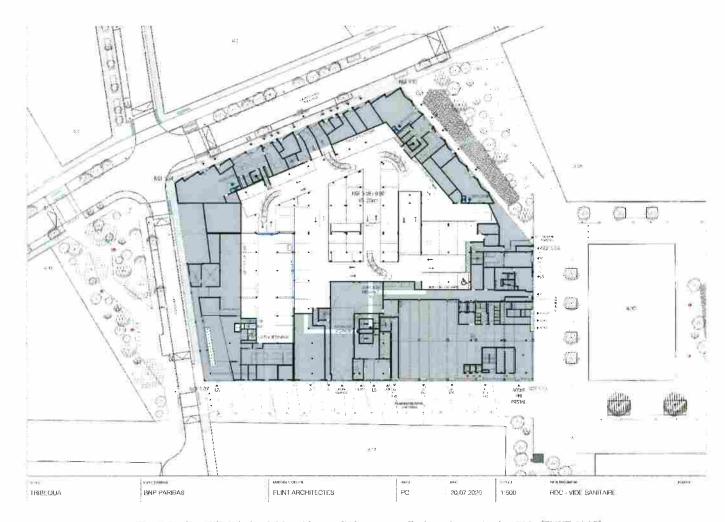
Plan PréPC du lot 8.3D - vides sanitaires et ventilations du rez de chaussée (FLINT 2020)
